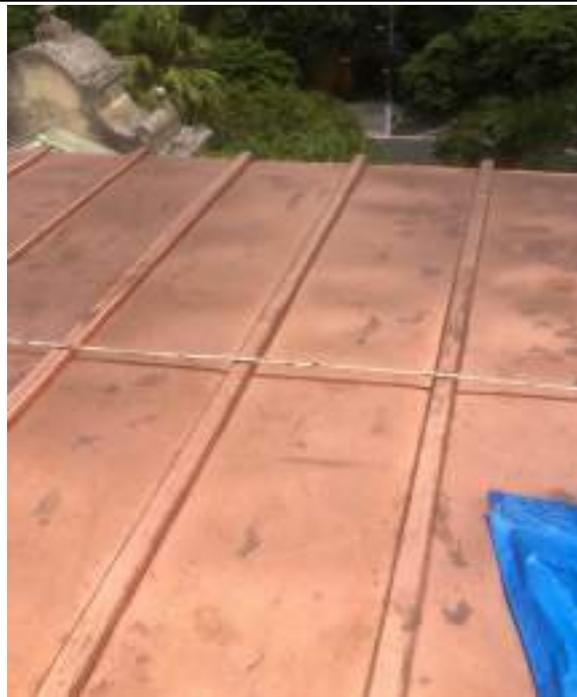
Conservação da cobertura, instalação de telhas em cobre e caibros de junção.
